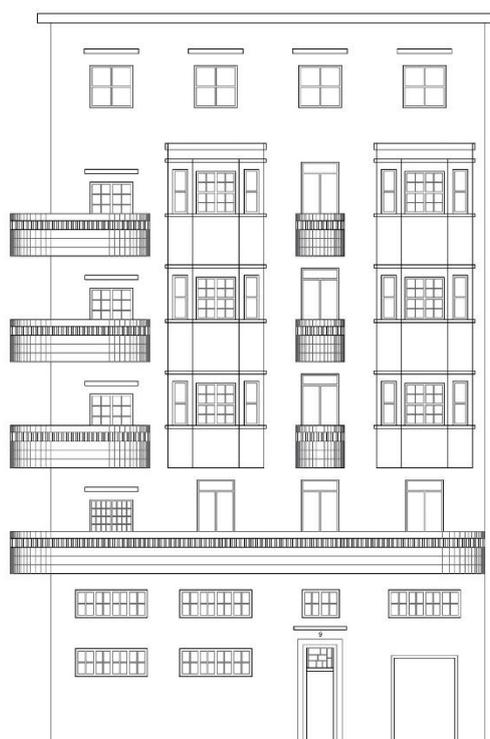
Bâtiment de style Art Déco, sur la rue Mohamed Belouizdad.
